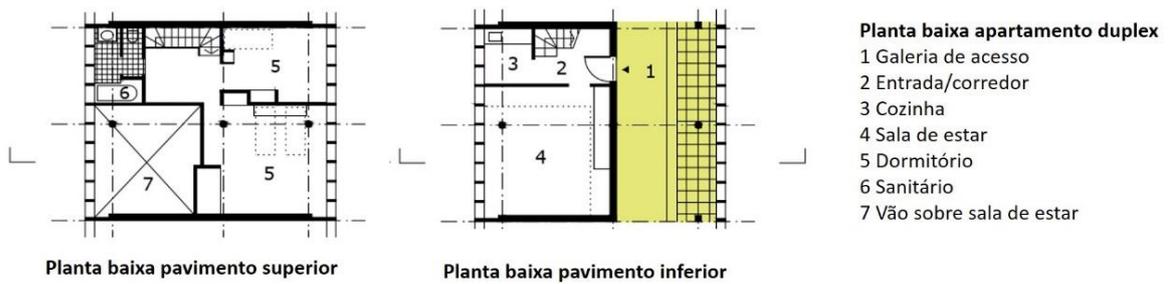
Plantas baixas apartamento tipo K- Narkomfin.
